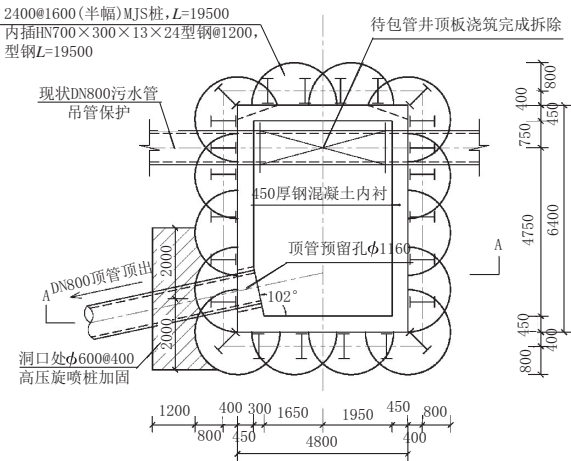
6a#包管井兼顶管工作井基坑平面图(单位:mm)
